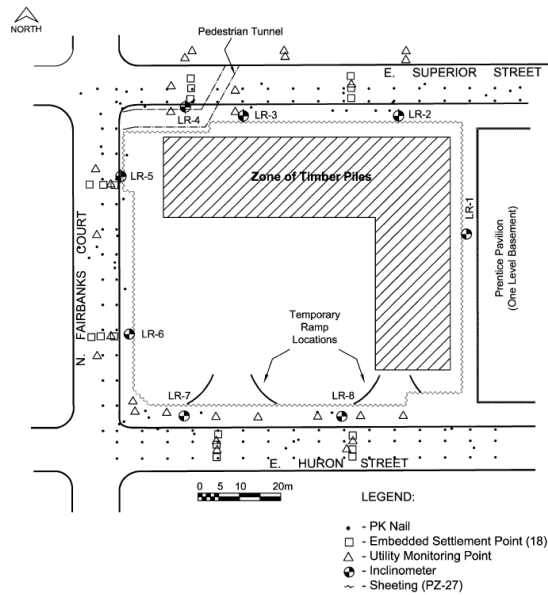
Vista en planta del sitio de excavación del Centro de Investigación de Lurie e instrumentación (Rechea et al., 2008)
